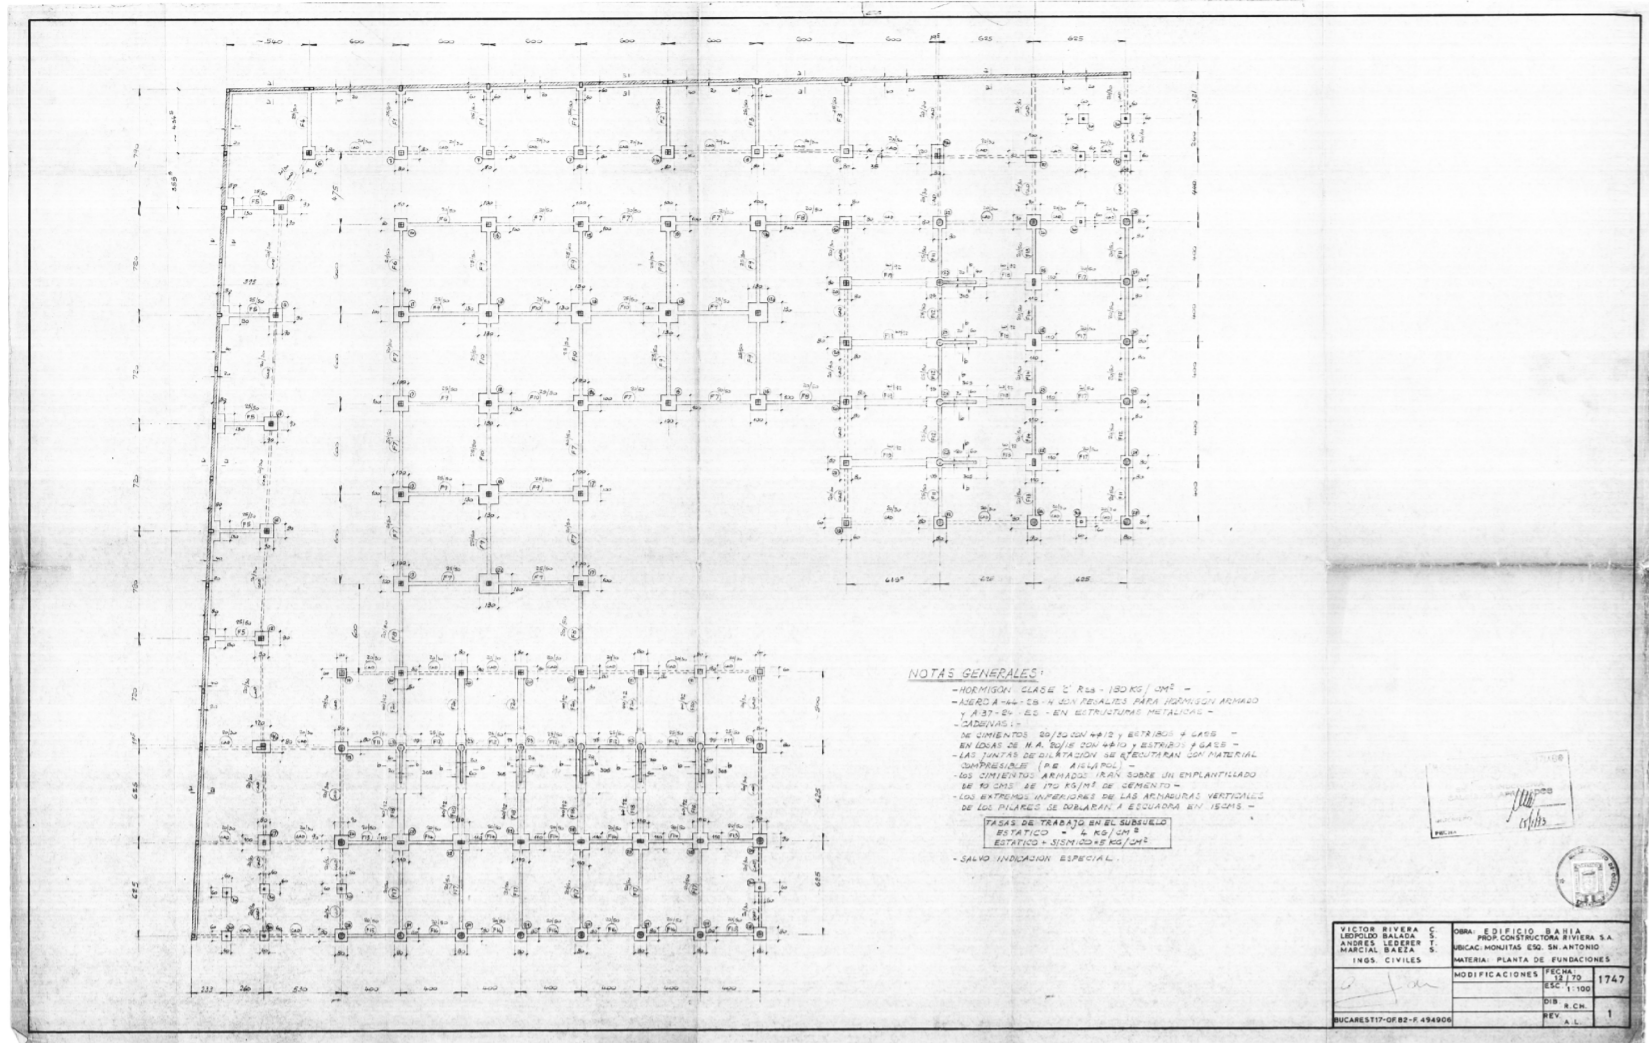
Archivo Plano Municipal. Planta fundaciones.
